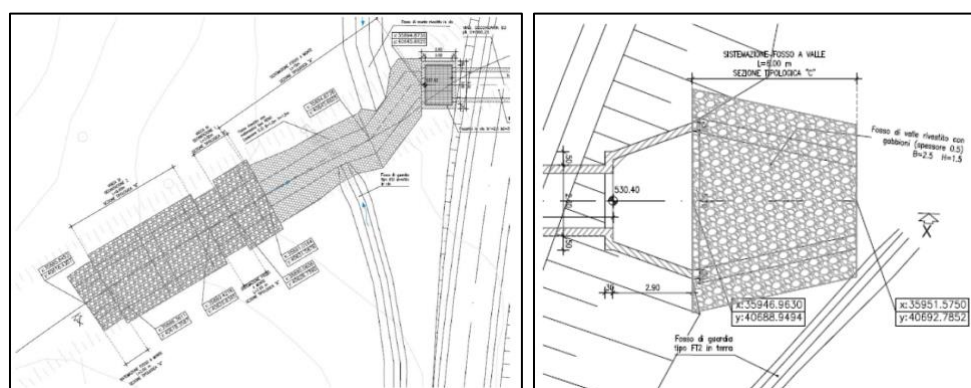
Stralcio planimetrico inalveazione a monte e a valle
